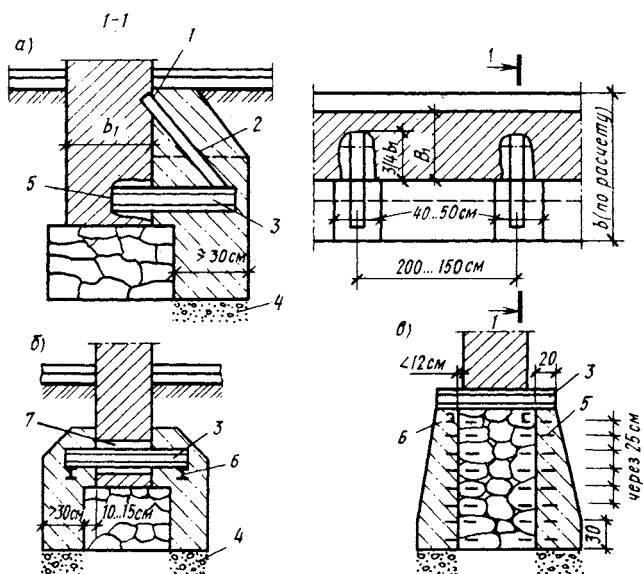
Уширение ленточных фундаментов монолитными банкетами:
